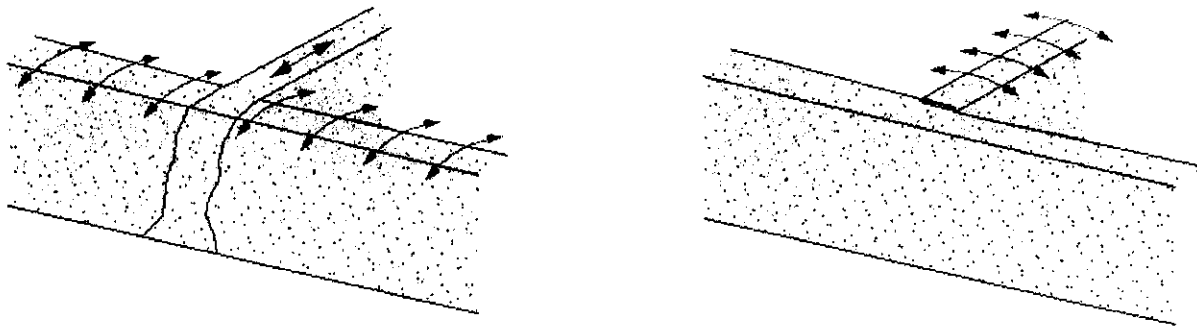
Fissurations verticales de jonctions des murs
